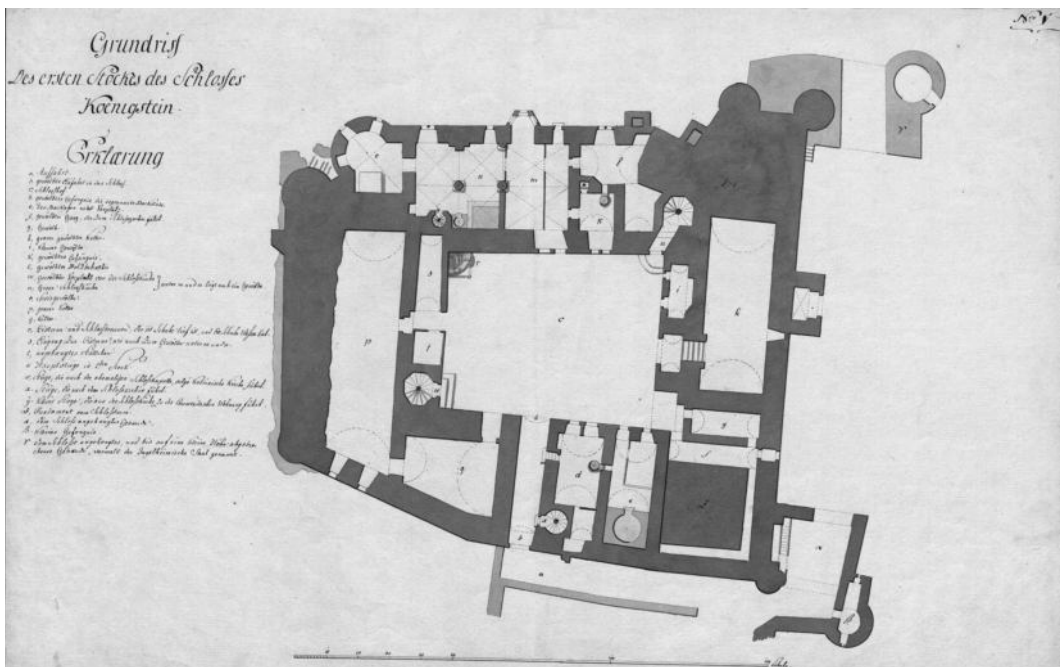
„Grundriss Des ersten Stockes des Schlosses Koenigstein“, Ingenieur-Oberleutnant Jean François Xavier Mangin, im Jahr 1790/1791.
